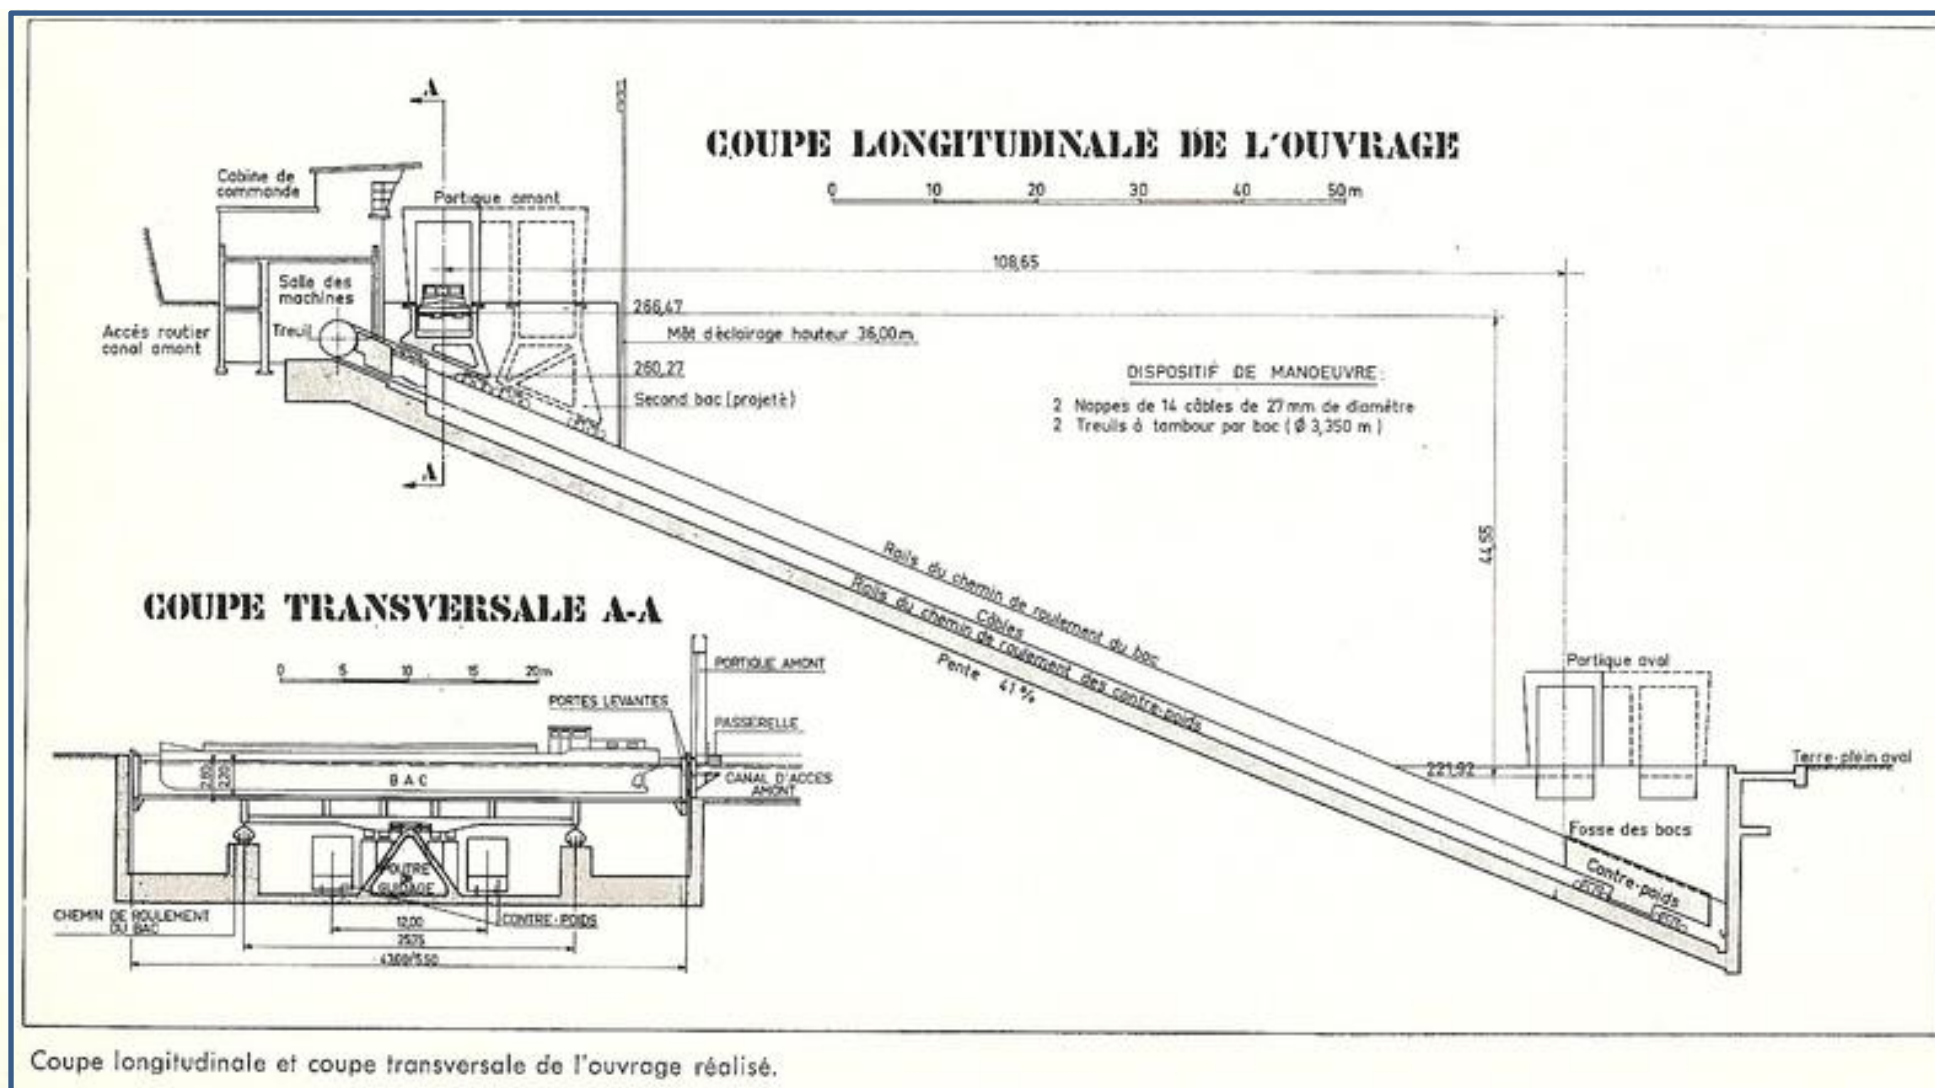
vue en coupe du projet retenu pour le plan incliné d'Arzwiller [56]
